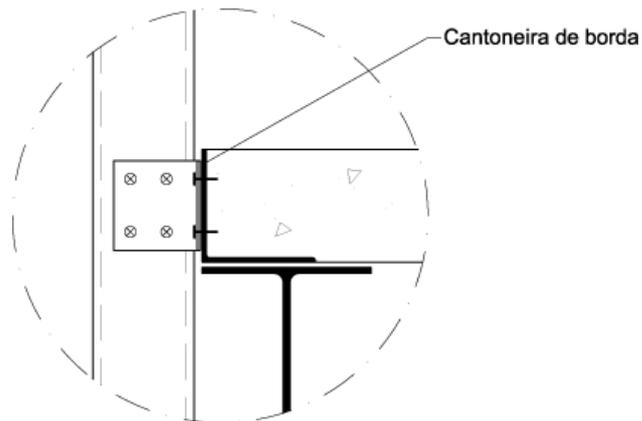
Cantoneira de reforço de borda de laje em concreto
